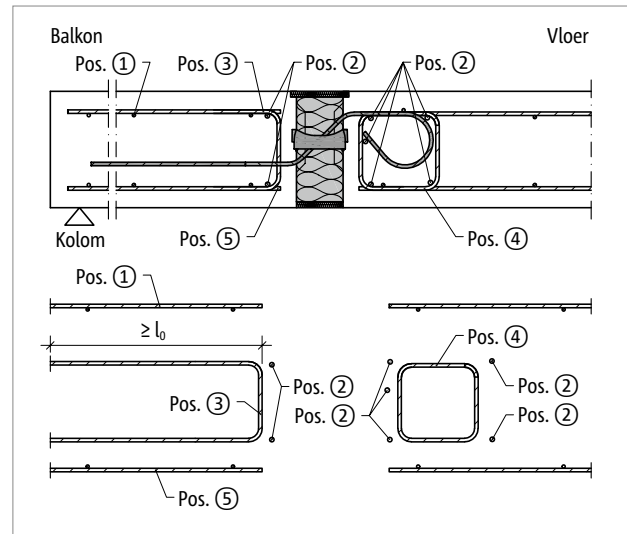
Schöck Isokorb® type Q-E-W-VV: Bijlegwapening
